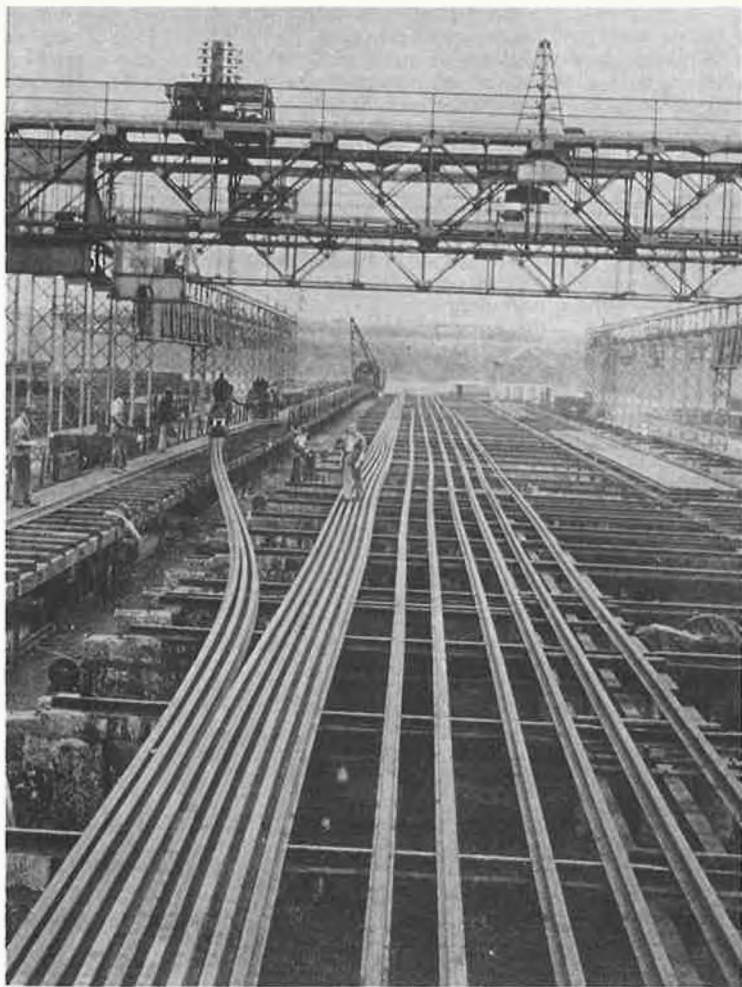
Chargement de barres longues soudées (216 m) au Dépôt Central de la Voie à Schaerbeek.
